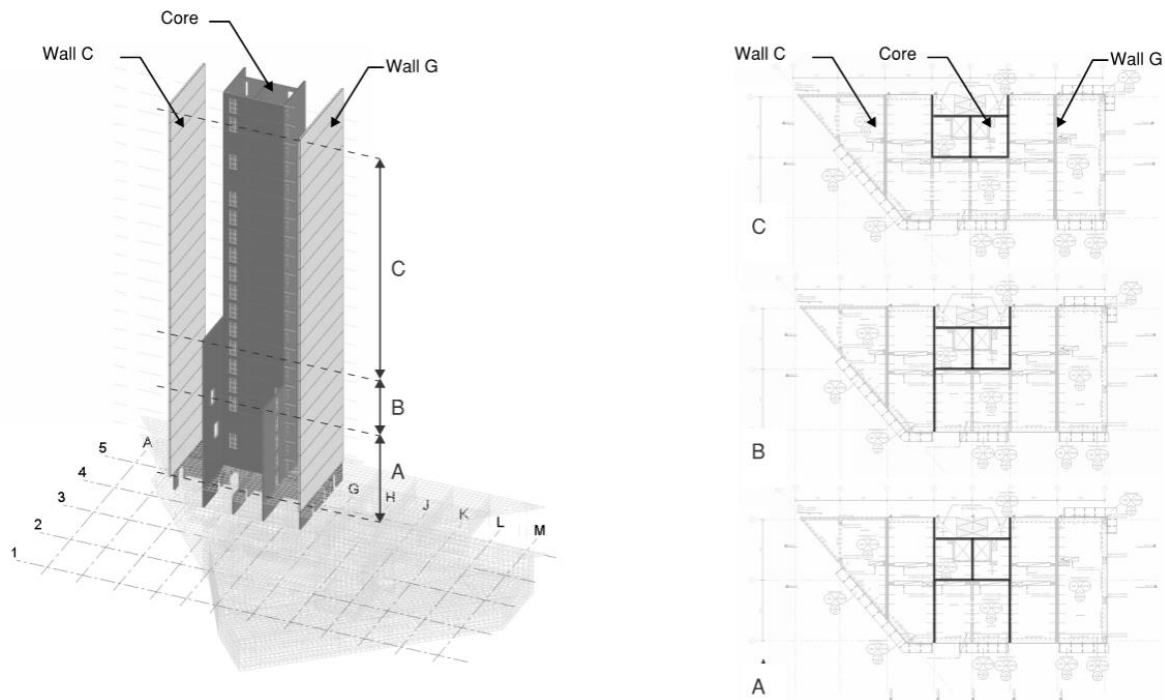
Das Aussteifungssystem des Projektes HAUT ist ein Hybridsystem aus Stahlbetonkern und Brettsperrholzwänden
